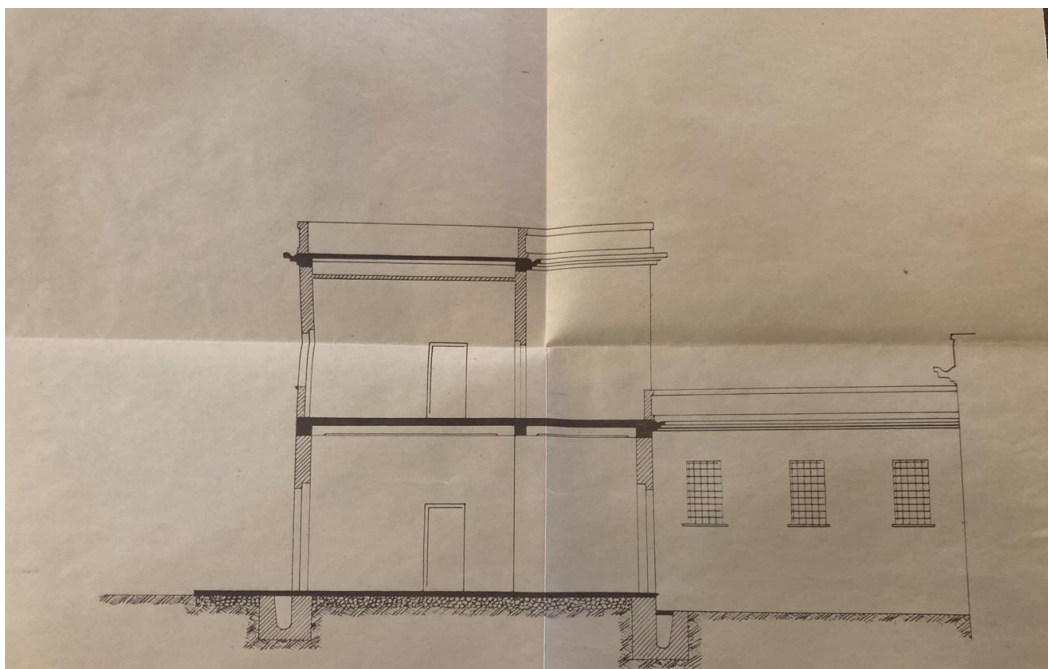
Sezione trasversale della caserma dei Vigili del Fuoco adiacente del progetto storico presente
